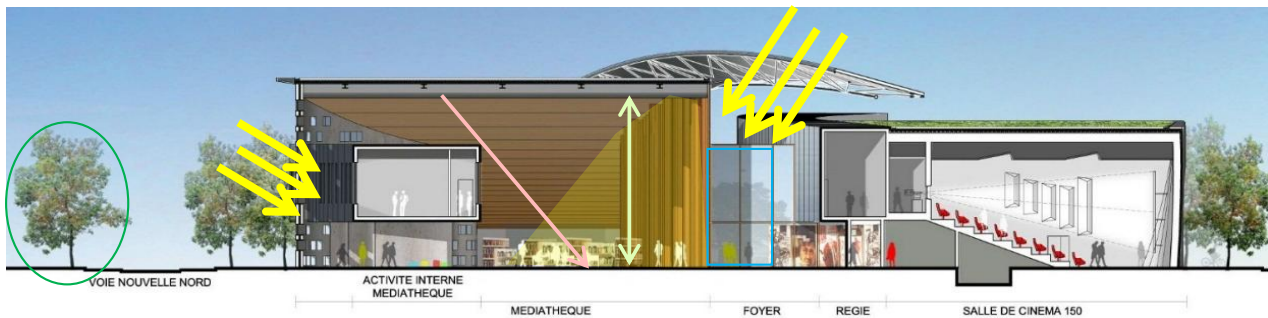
Coupe Transversale A-A Source : www.actuarchi.com
